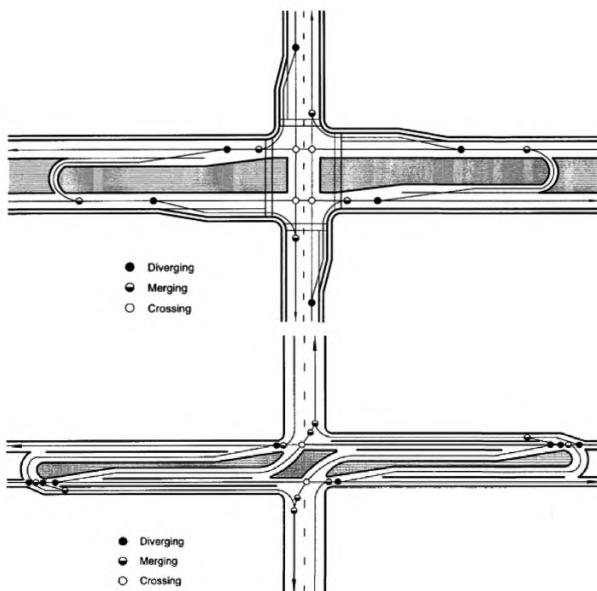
Сокращение числа конфликтных точек на пересечении за счет удаления от места пересечения маршрутов для лево-поворотных съездов.
